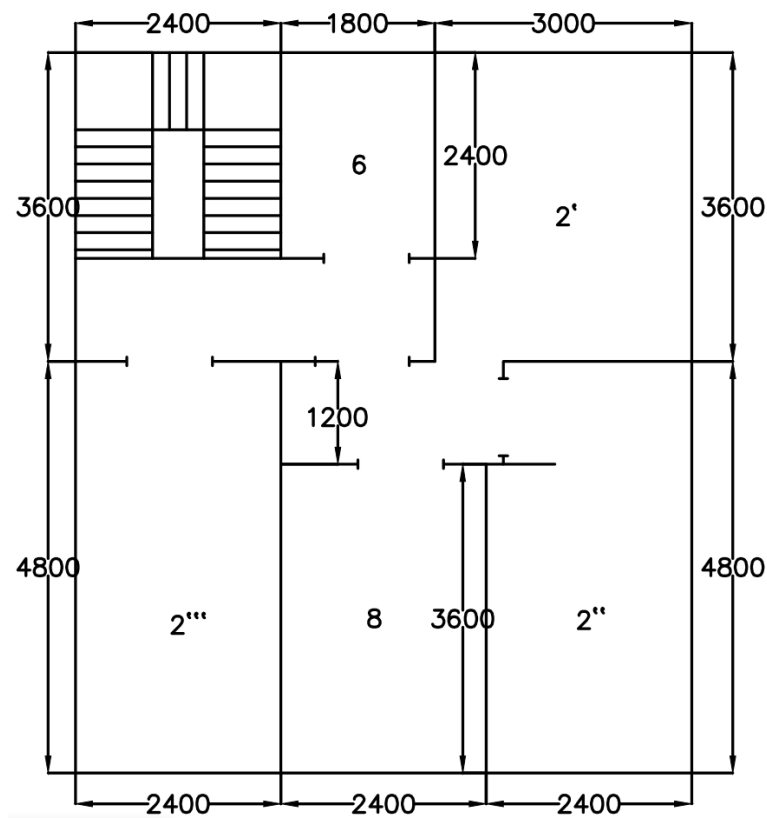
Размещение элементов 1-го этажа двухэтажного жилого дома
